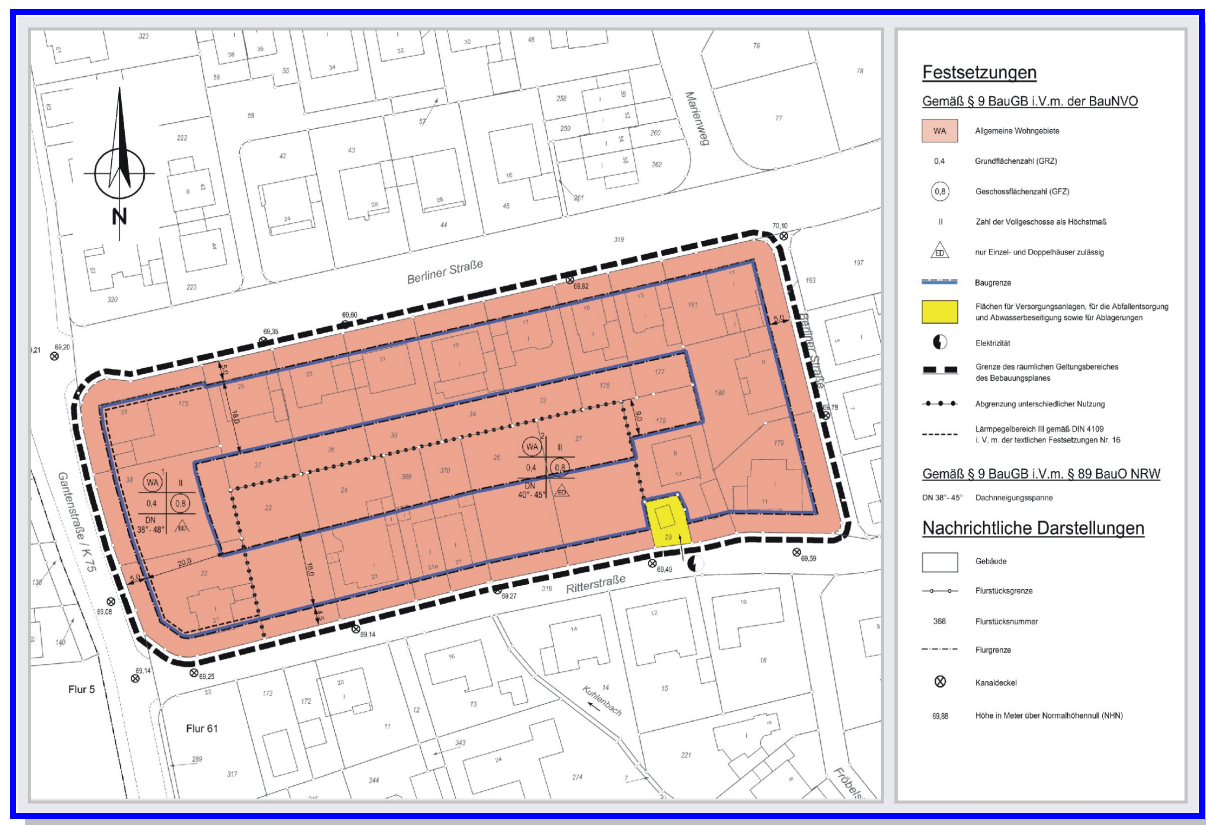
Geänderter Bebauungsplan (STADT STEINFURT 2023)
